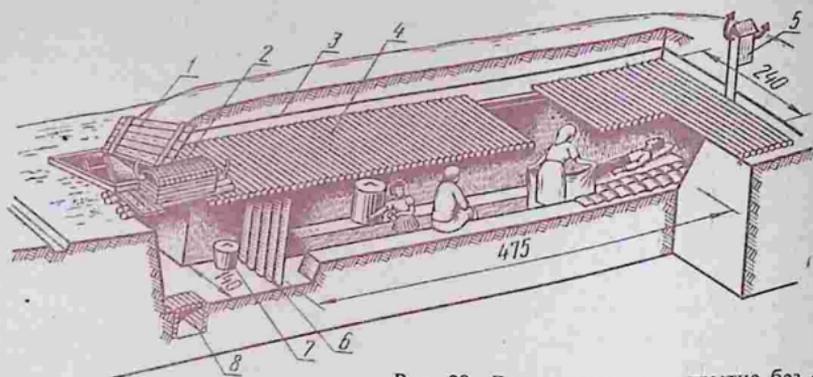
Дерево-земляное укрытие без одежды крутостей в глинистых грунтах на 10 человек:
